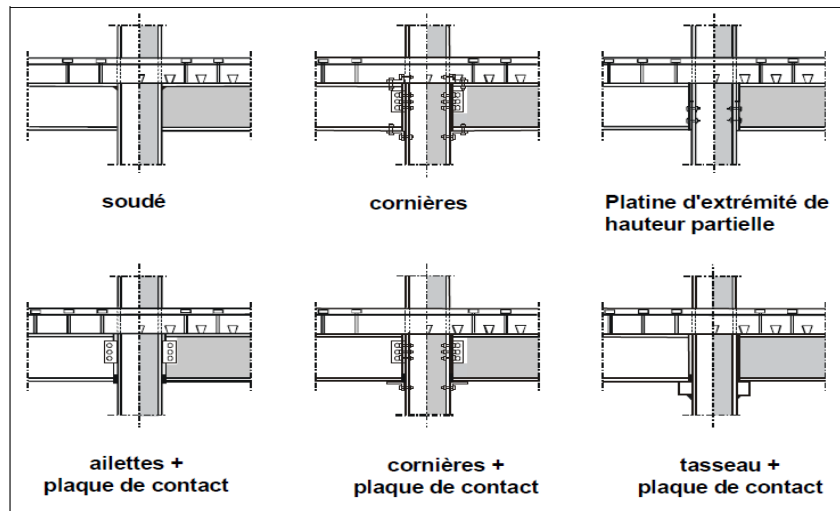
Types d'assemblages –Poteau à section en H et poutre à section en I
